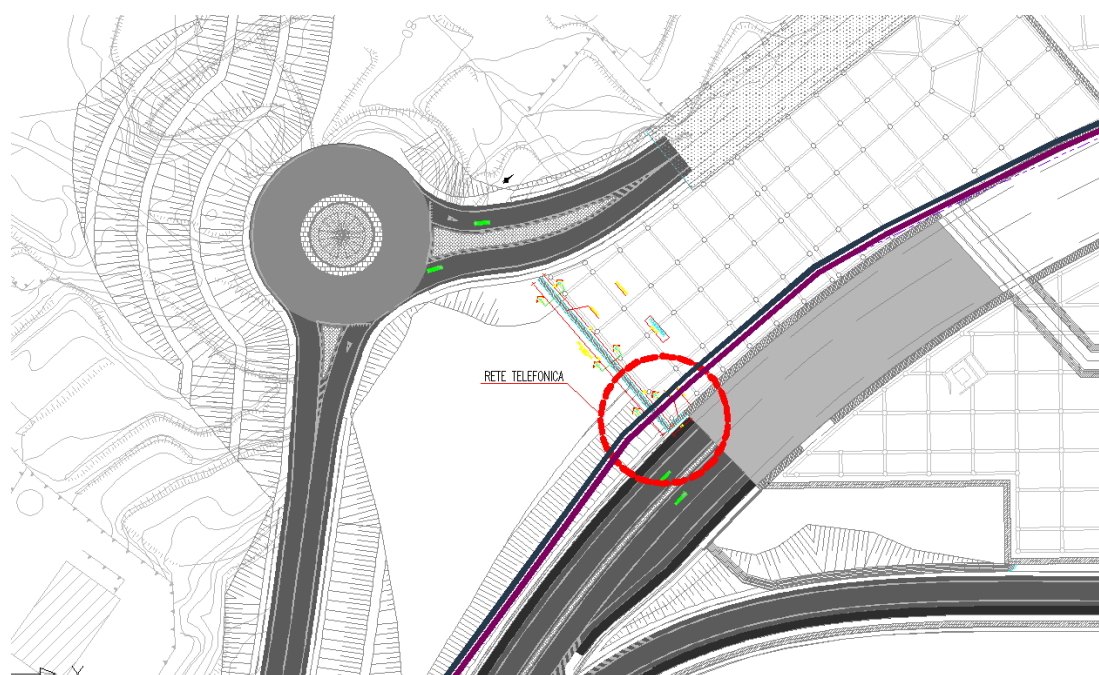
Stralcio planimetrico con l'individuazione delle interferenze
